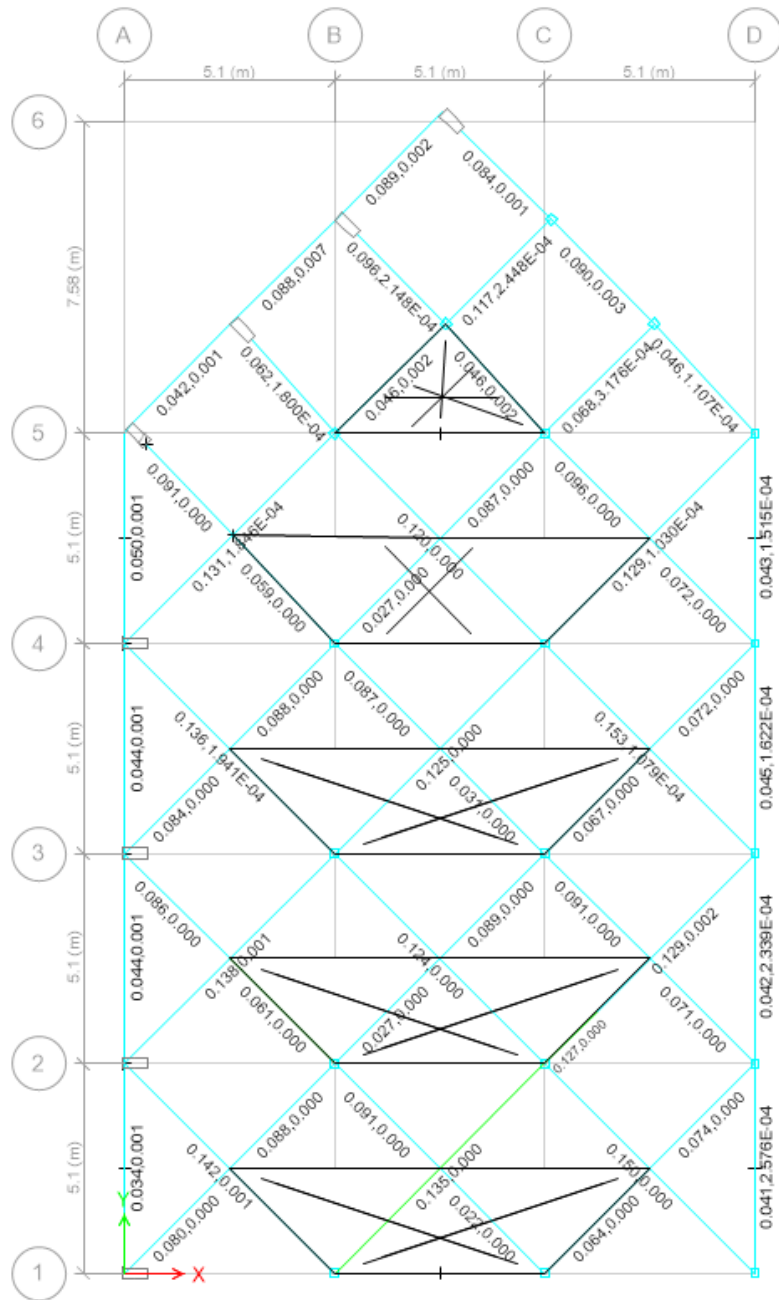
Demanda/capacidad a solicitaciones de corte en miembros estructurales N+10.30m
